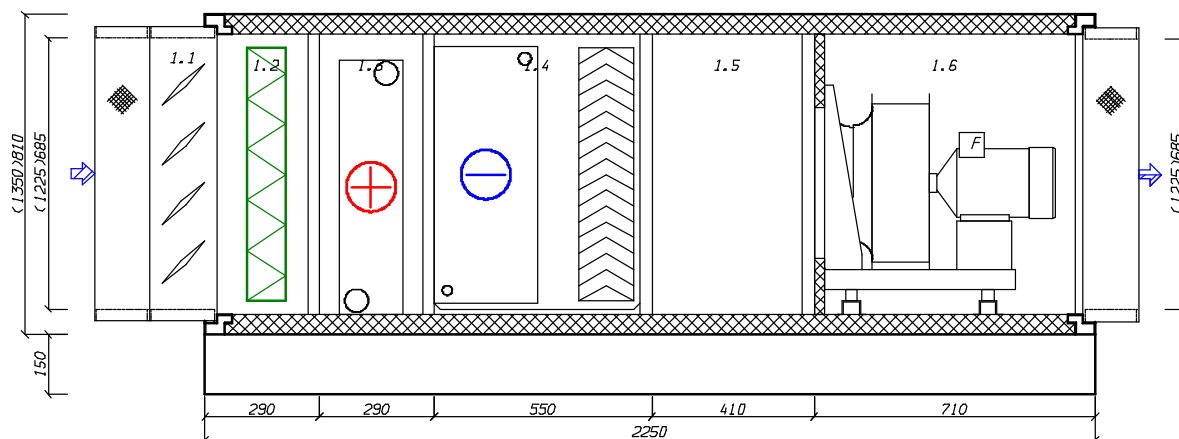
Установка ВЕРОСА-500-078-03-00-У3
